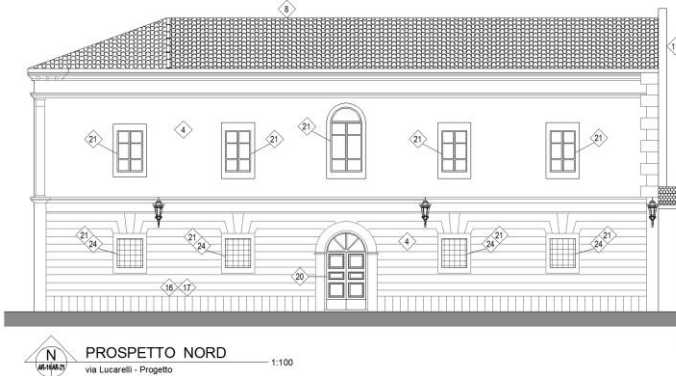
Prospetto Nord, Progetto (Elaborato grafico degli Autori)
